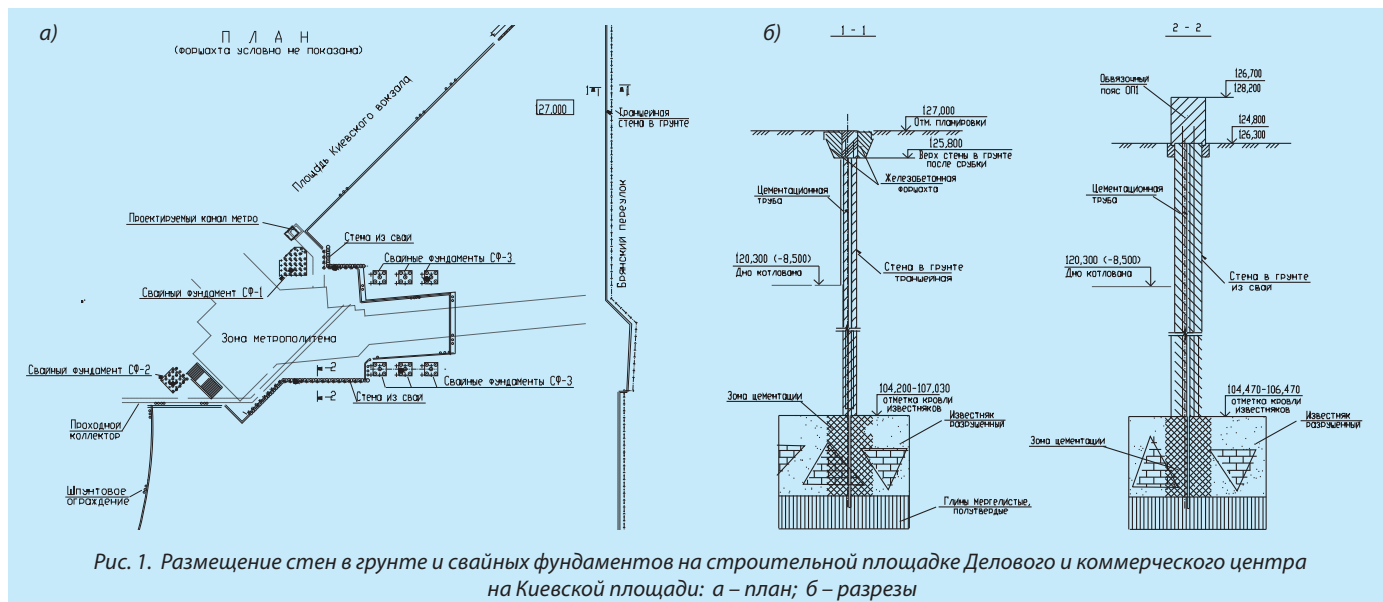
Размещение стен в грунте и свайных фундаментов на строительной площадке Делового и коммерческого центра на Киевской площади: а — план; б — разрезы
